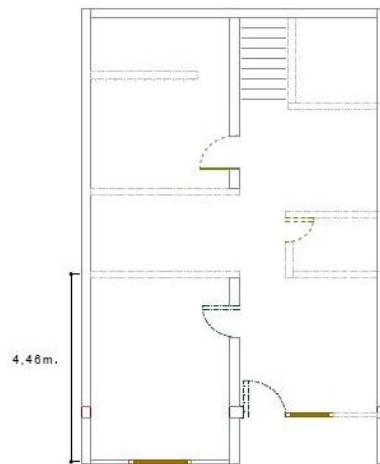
Planta estructural segundo piso, Casa Buenos Aires
